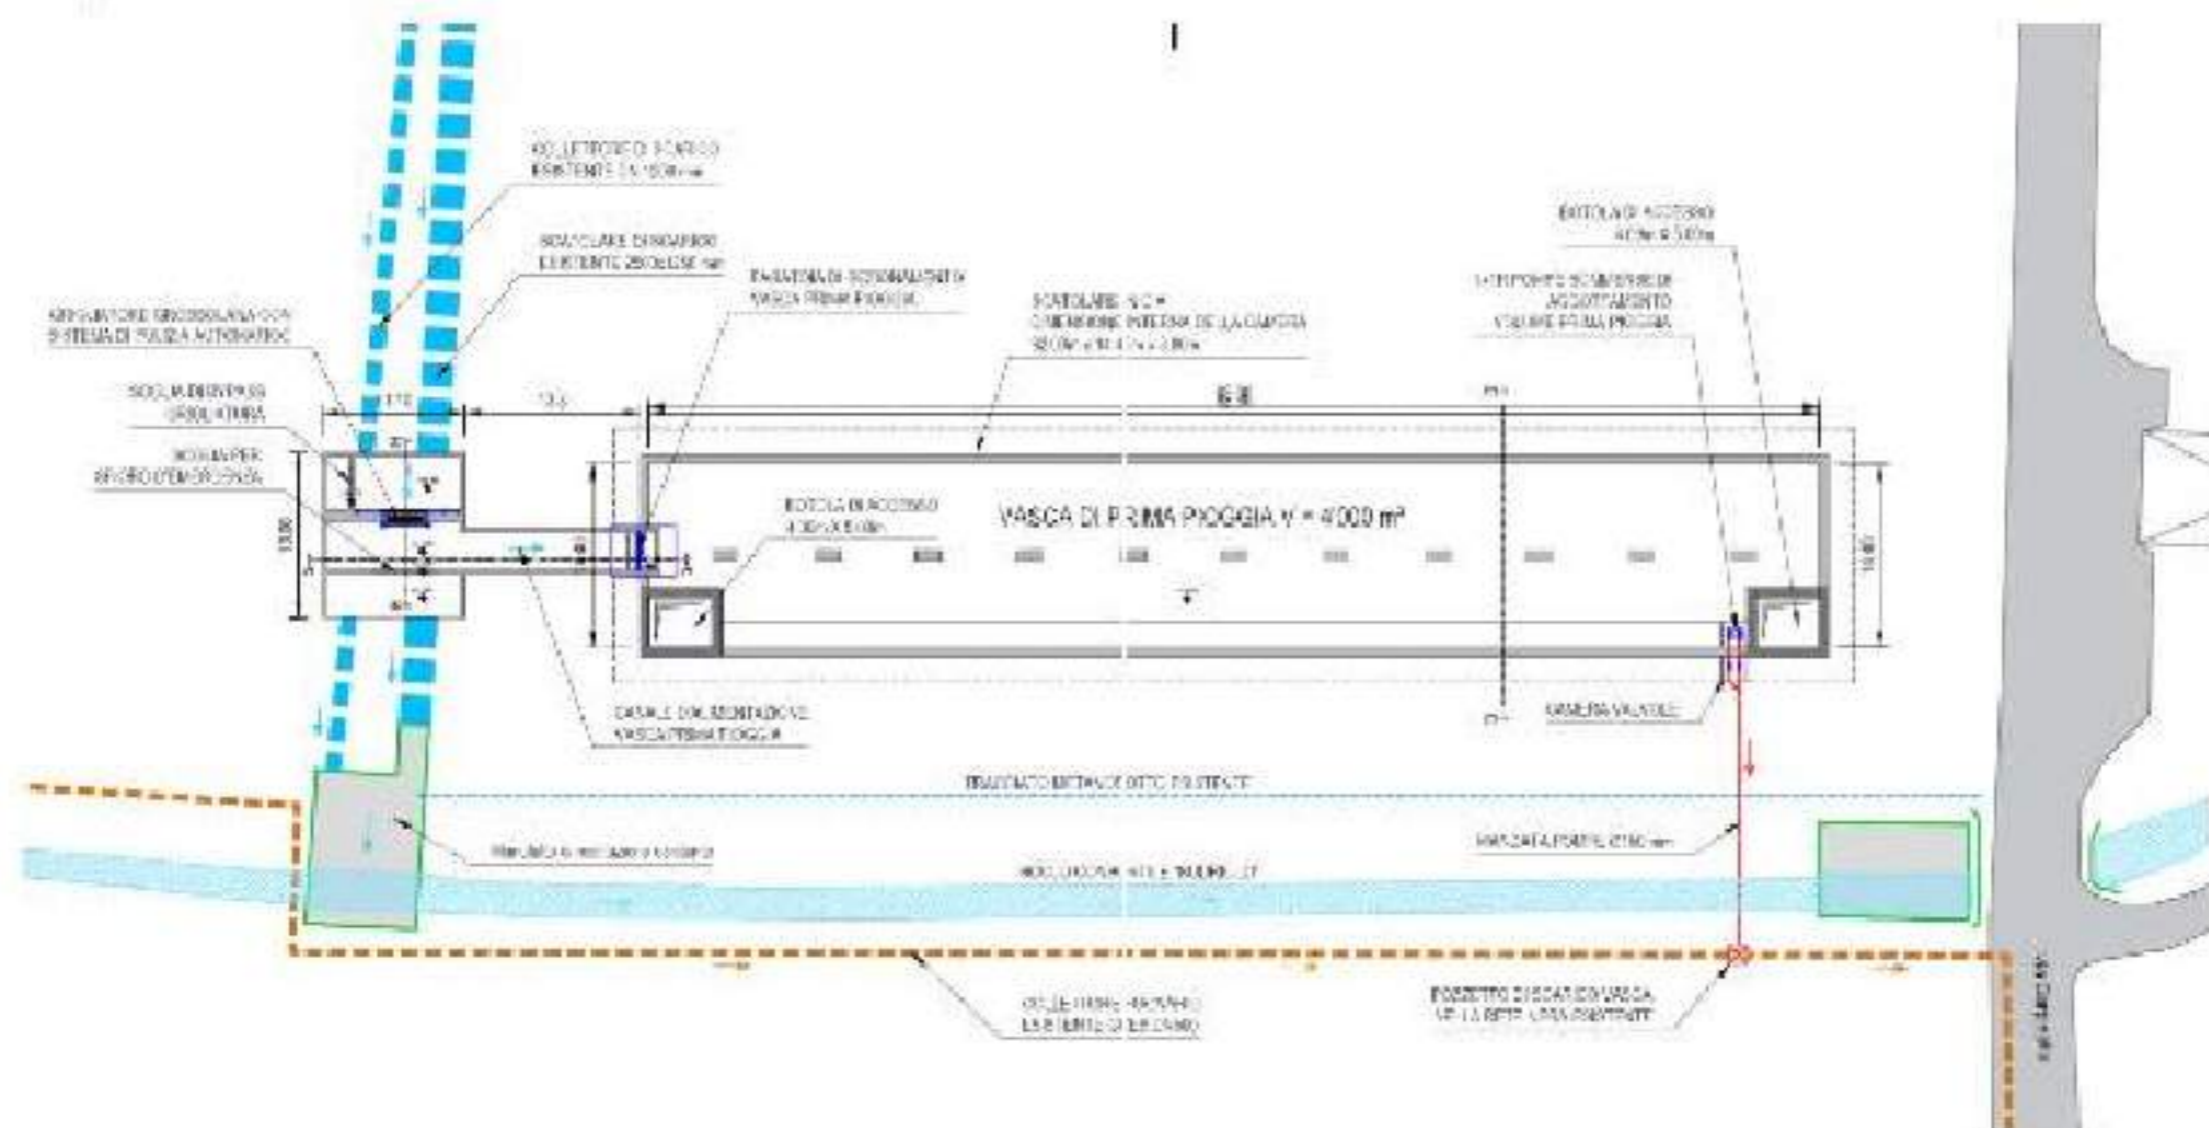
Vasca di prima pioggia – Pianta opere di progetto
